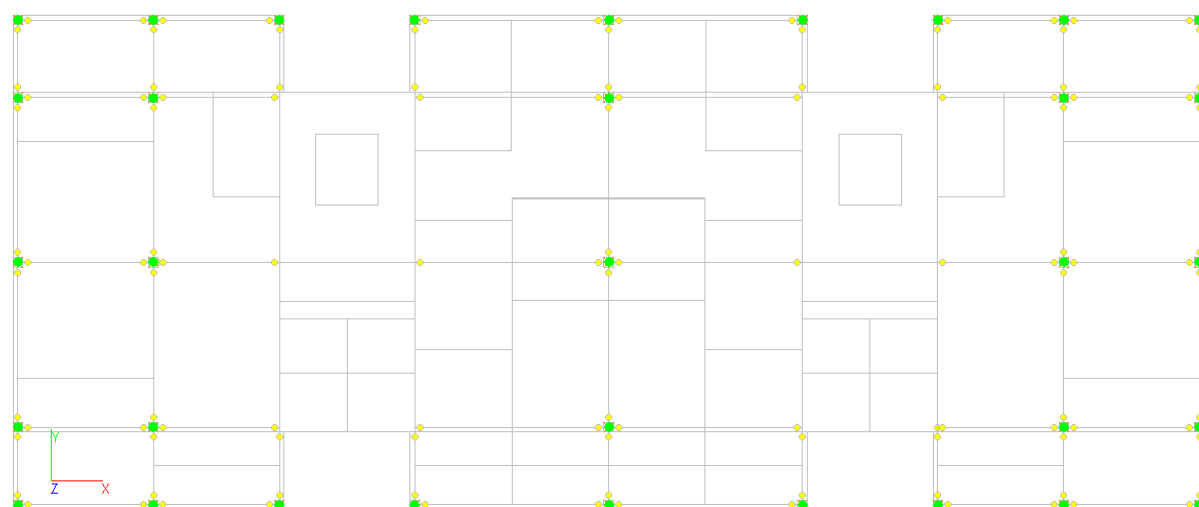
Установка шарниров в местах примыкания балок к колоннам, балок к монолитному каркасу
